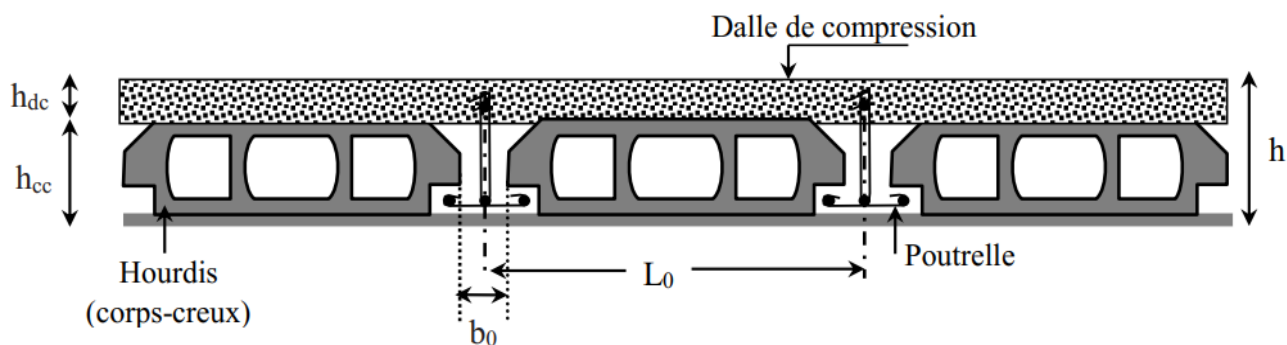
Coupe transversale d'un plancher à corps creux
